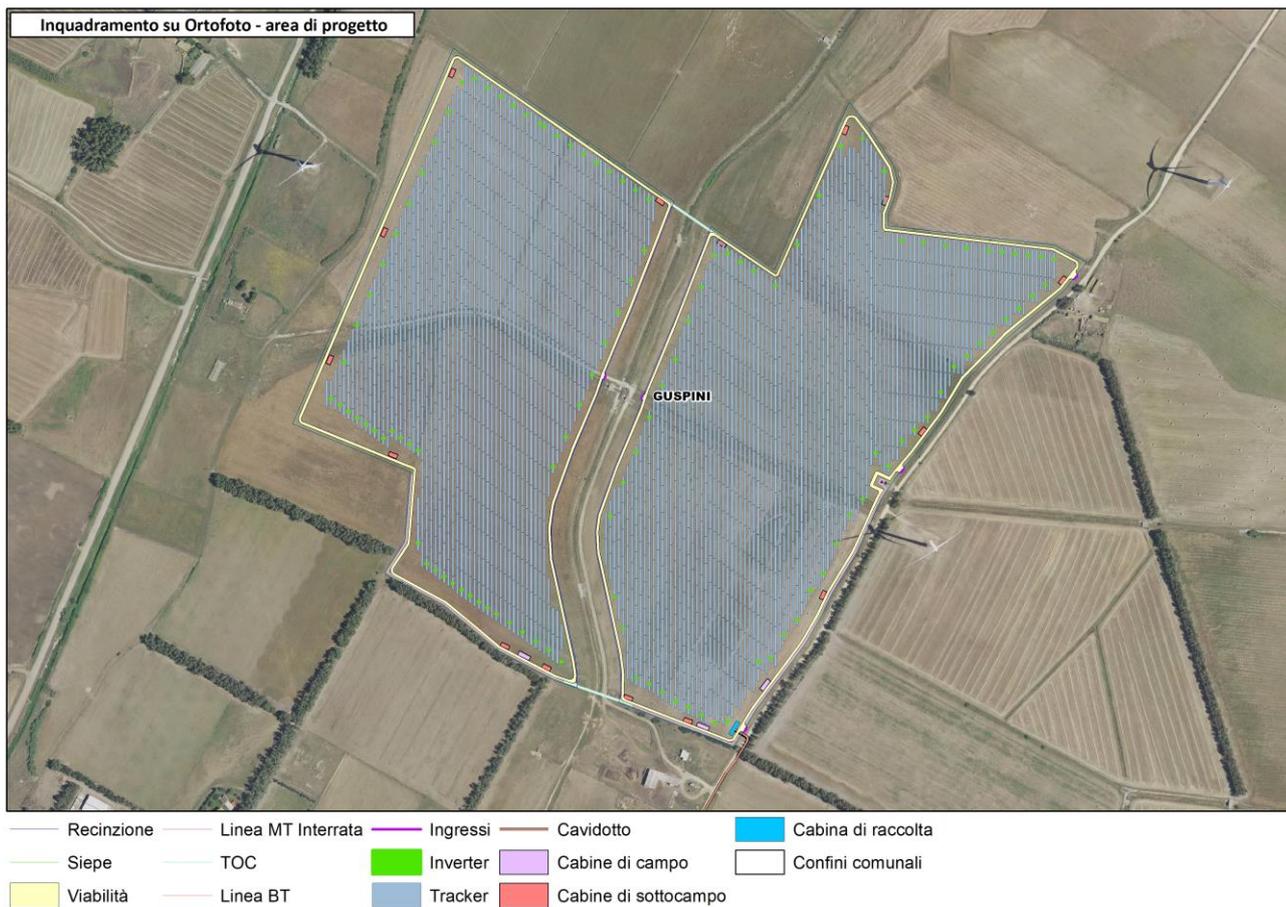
inquadramento su ortofoto - vista di dettaglio.
